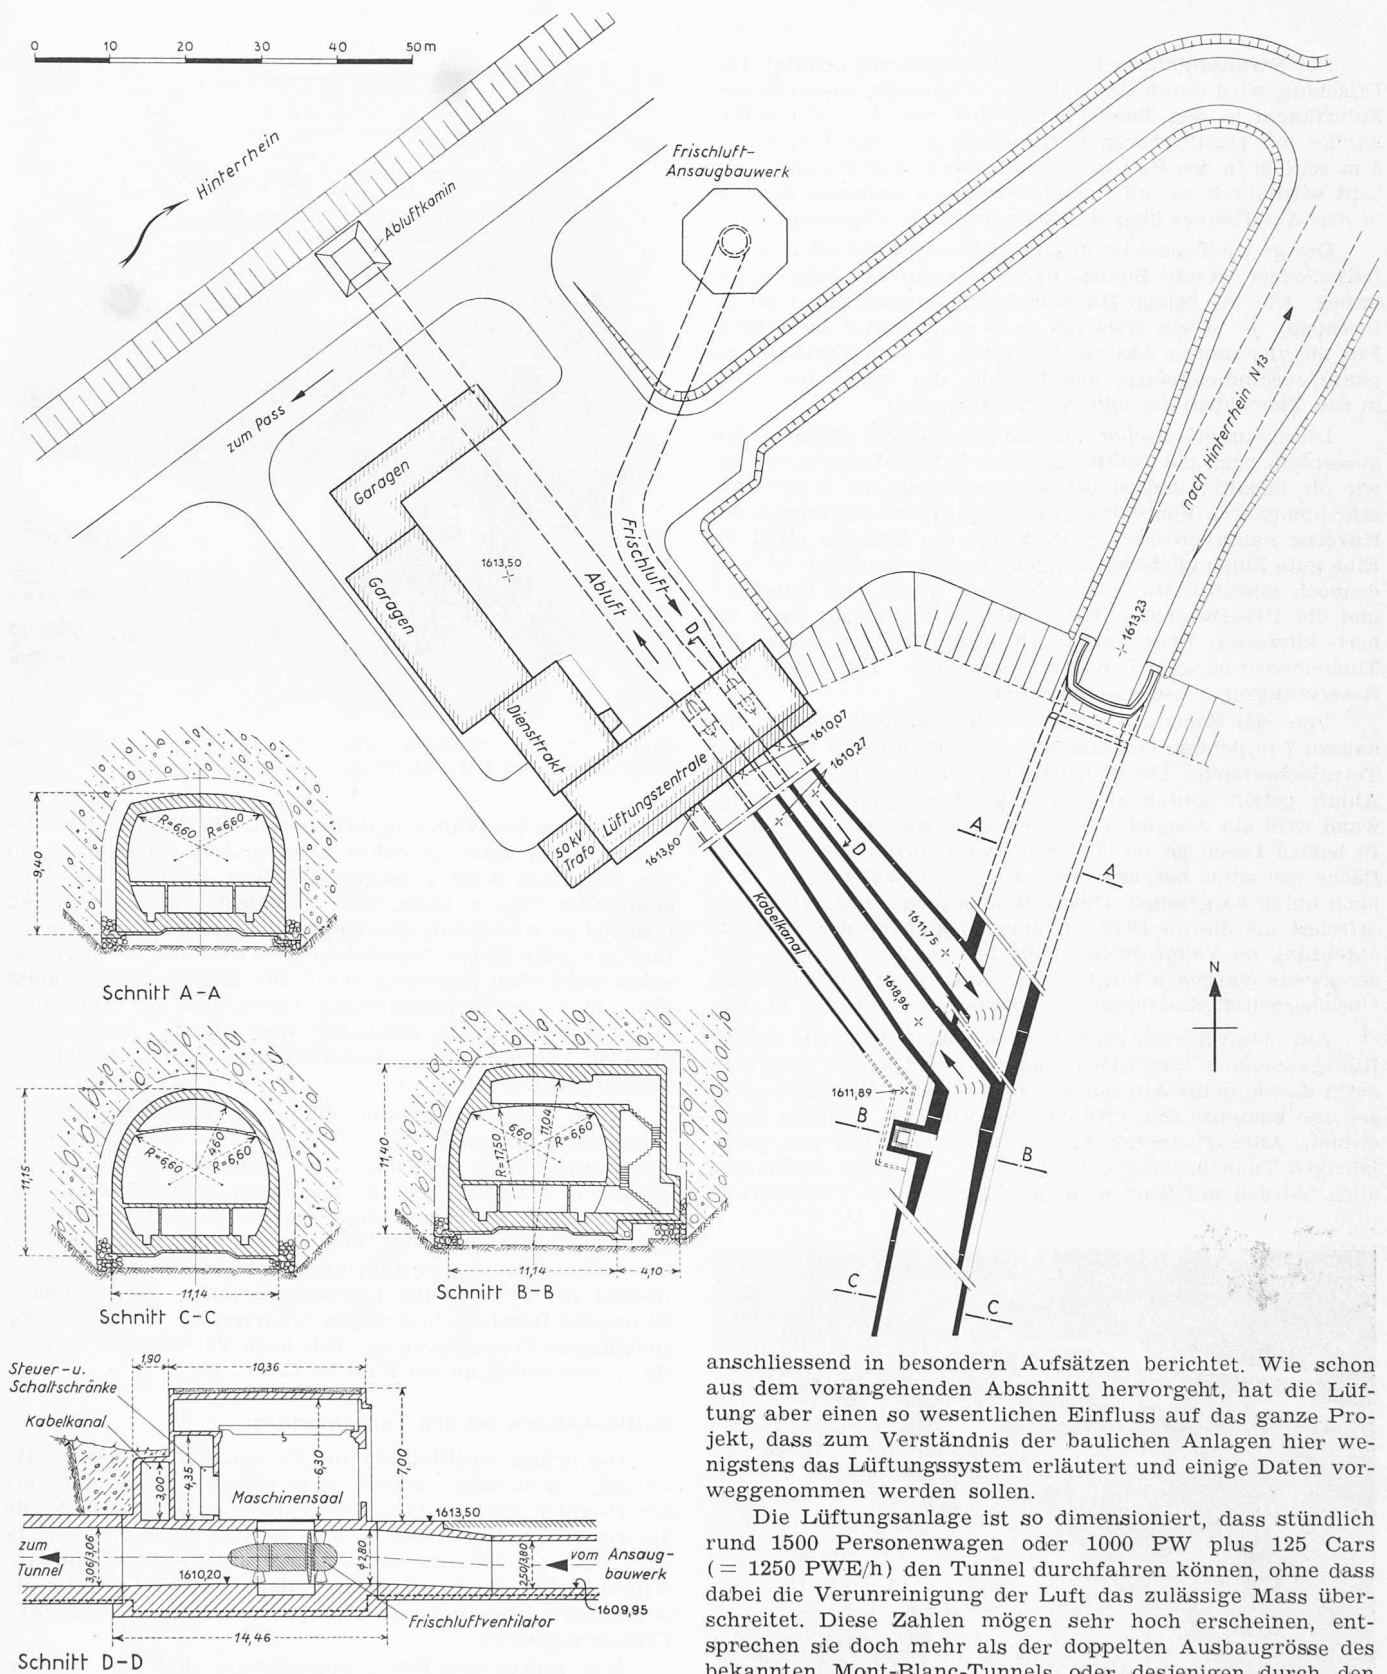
Nordportal mit oberirdischer Lüftungszentrale und Betriebsgebäuden; Lageplan 1:1000, Schnitte A bis C 1:500, Schnitt D 1:400
